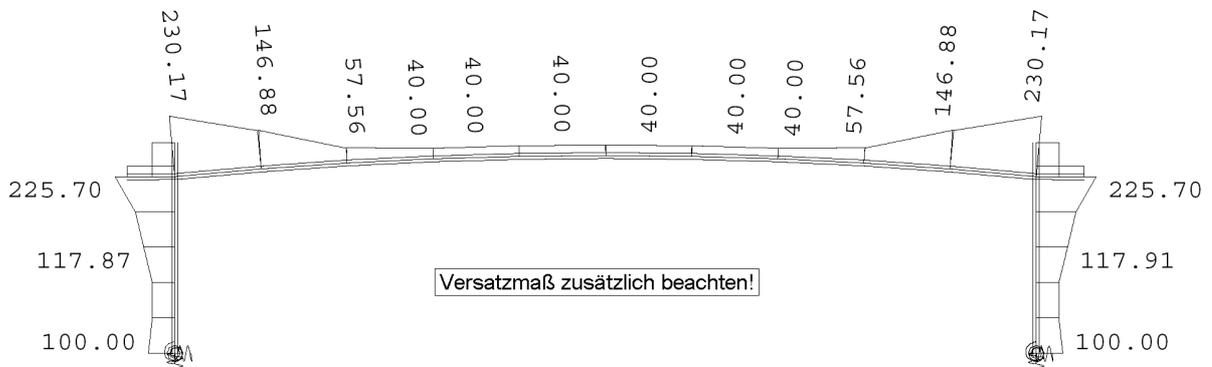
erforderliche Bewehrung im GZT, Rang 2 („oben“ bzw. außen) erf A_s [cm²]
